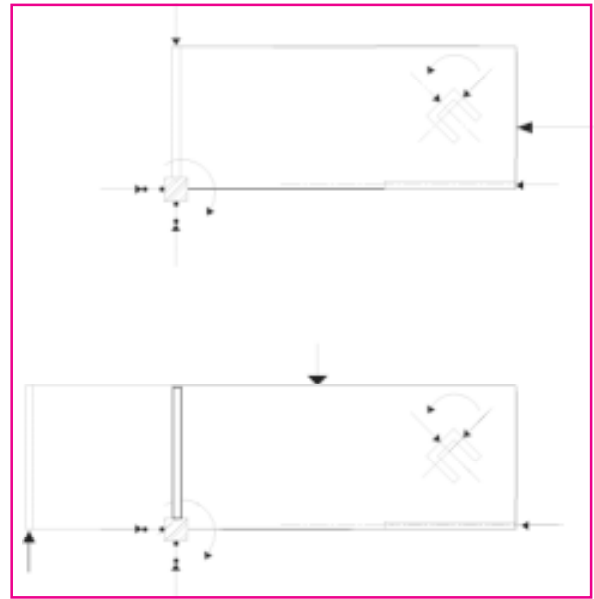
Planta de la Edificación. Ejemplo Numérico.
